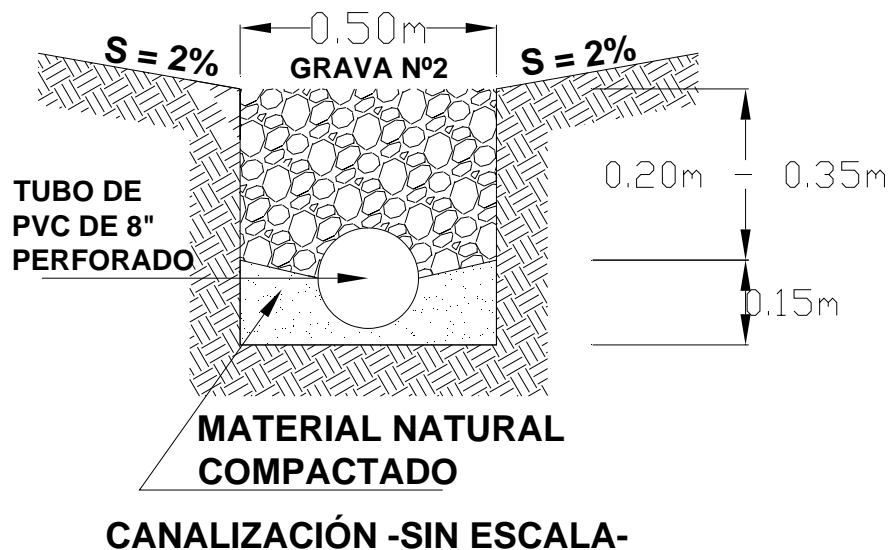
Detalle de canaleta de drenaje para líquidos lixiviados.
